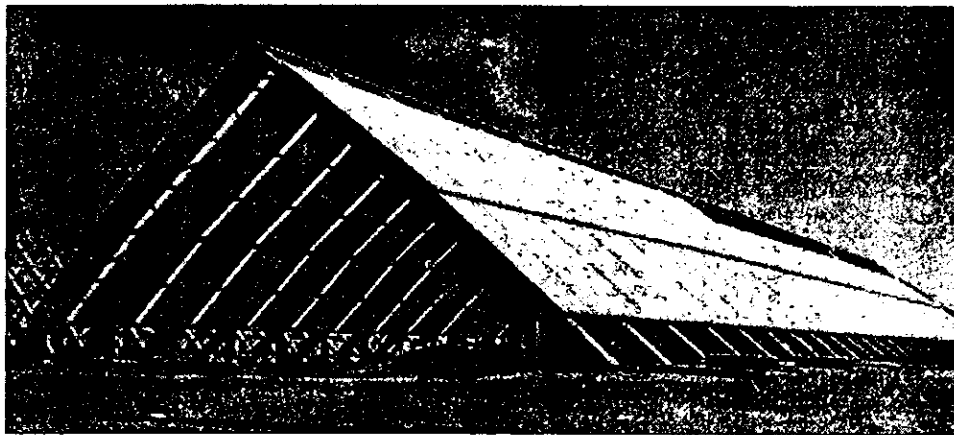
Vista general de los Silos de concreto prefabricado de Lázaro Cárdenas Michoacán.
